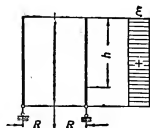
Деформации в цилиндрической оболочке от равномерного нагревания.
